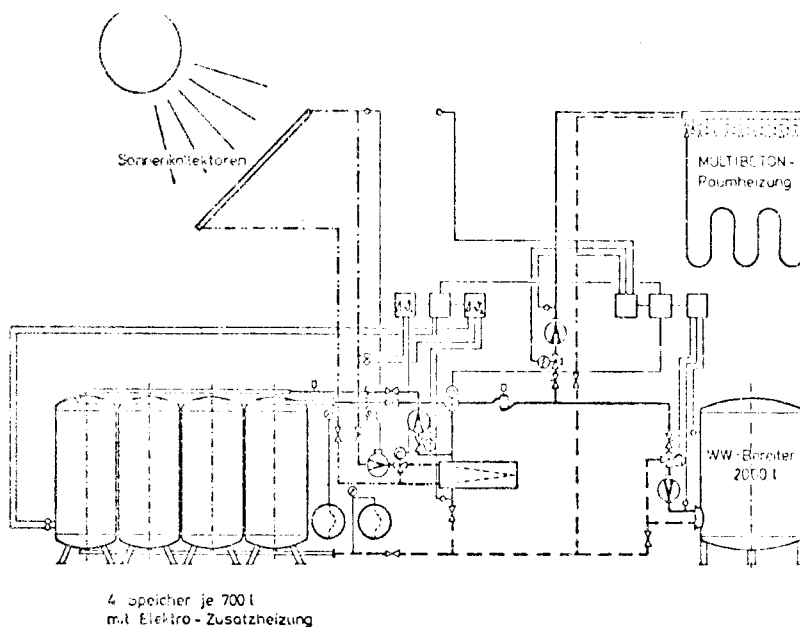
Schaltschema der Multibeton-Fußbodenheizung und Warmwasserbereitung mit Sonnenkollektoren
